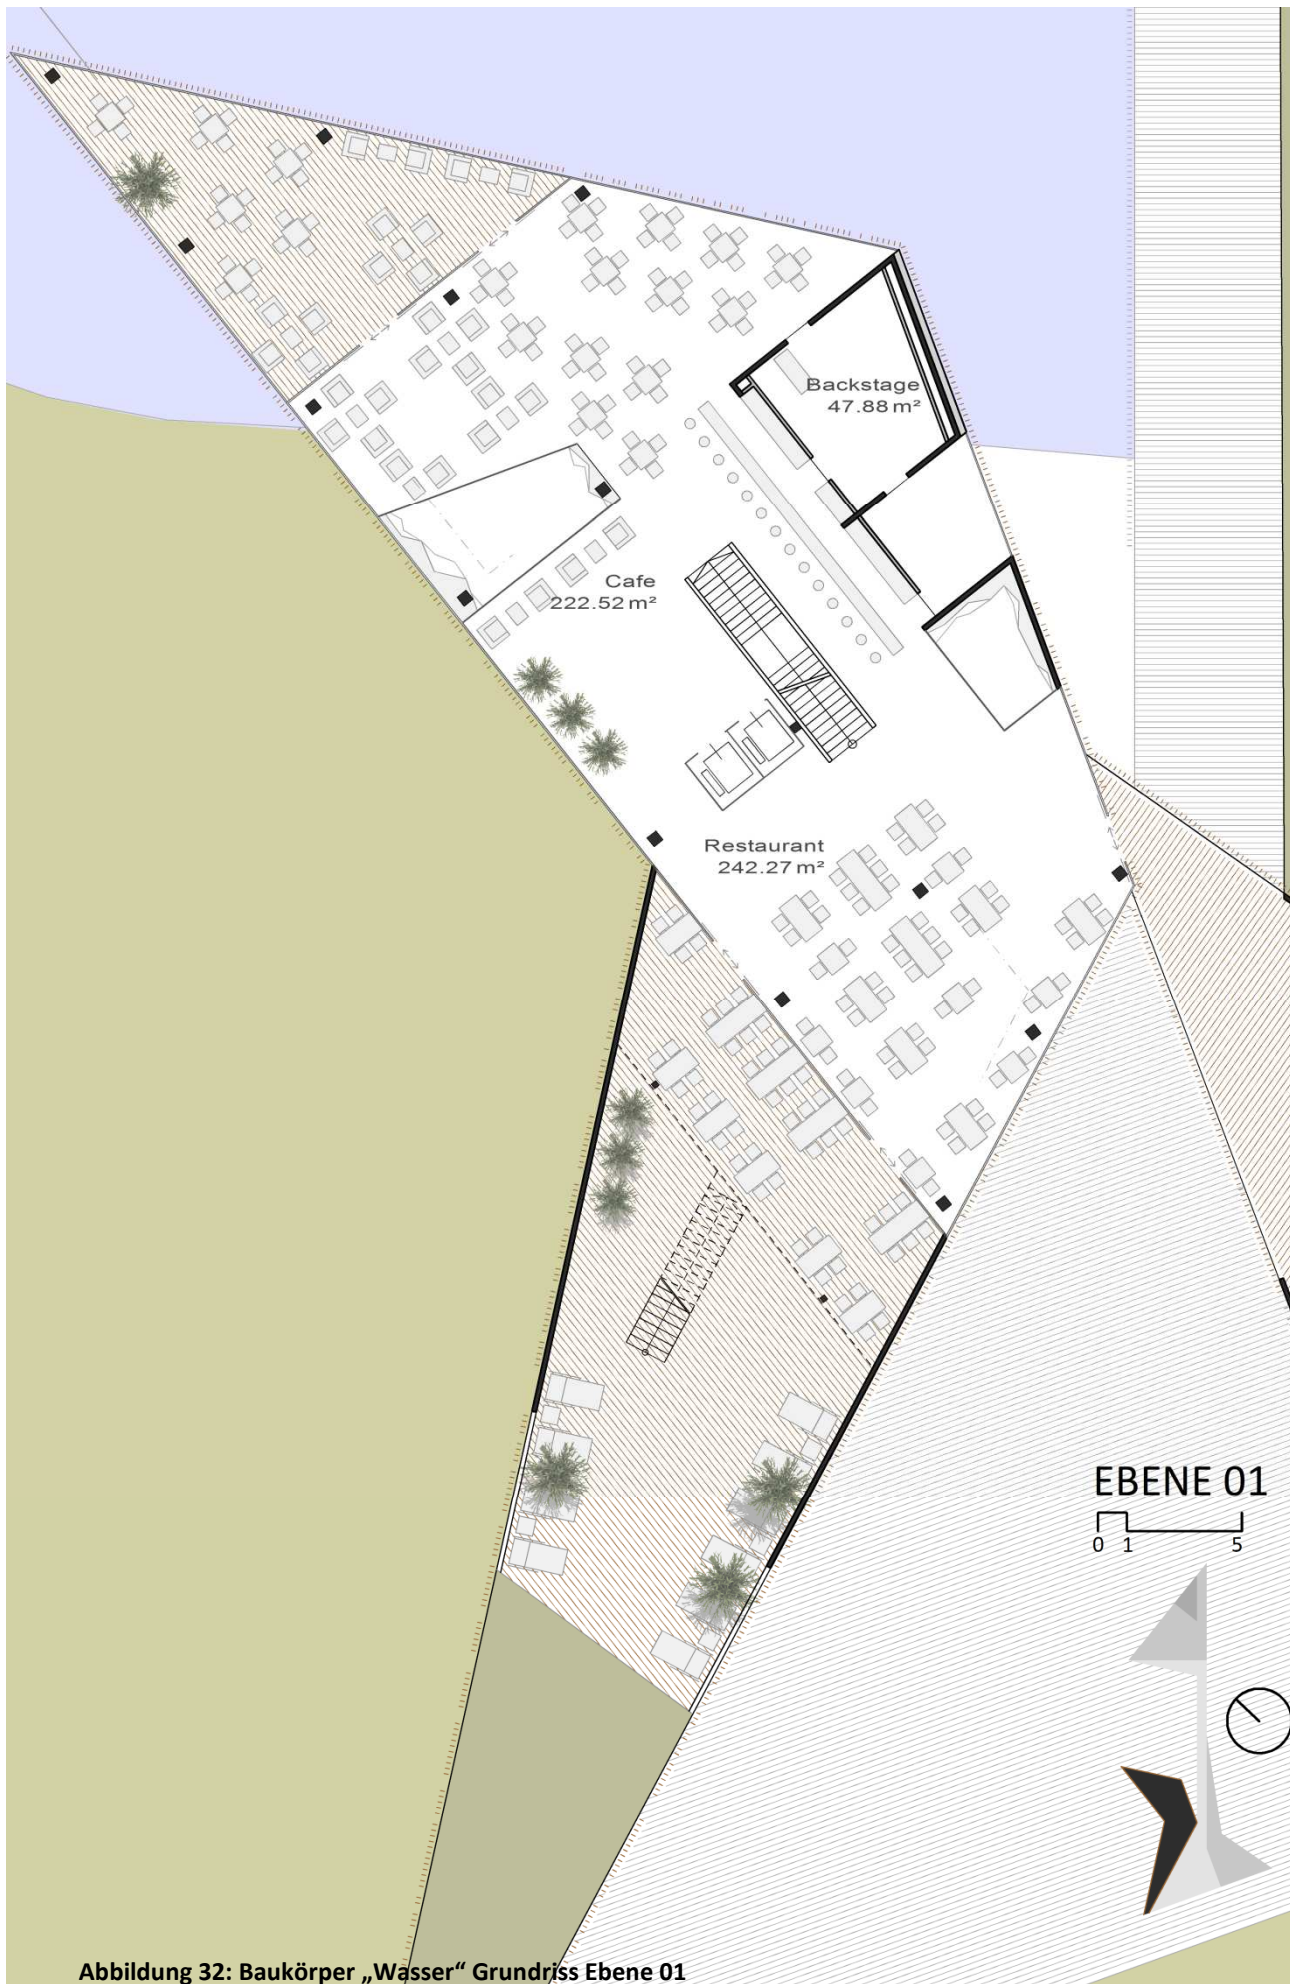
Baukörper „Wasser“ Grundriss Ebene 01
